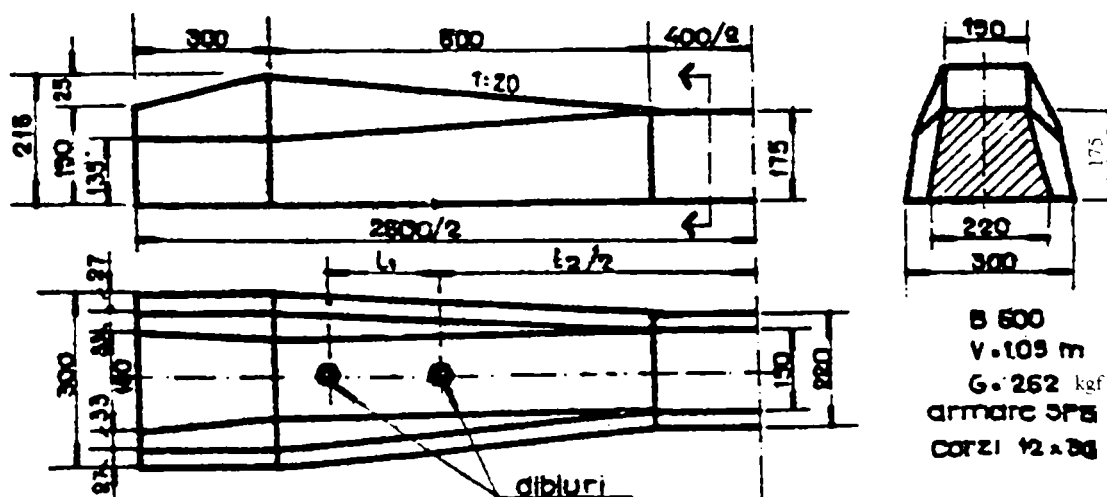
Traversa din beton armat precomprimat T_{17}
